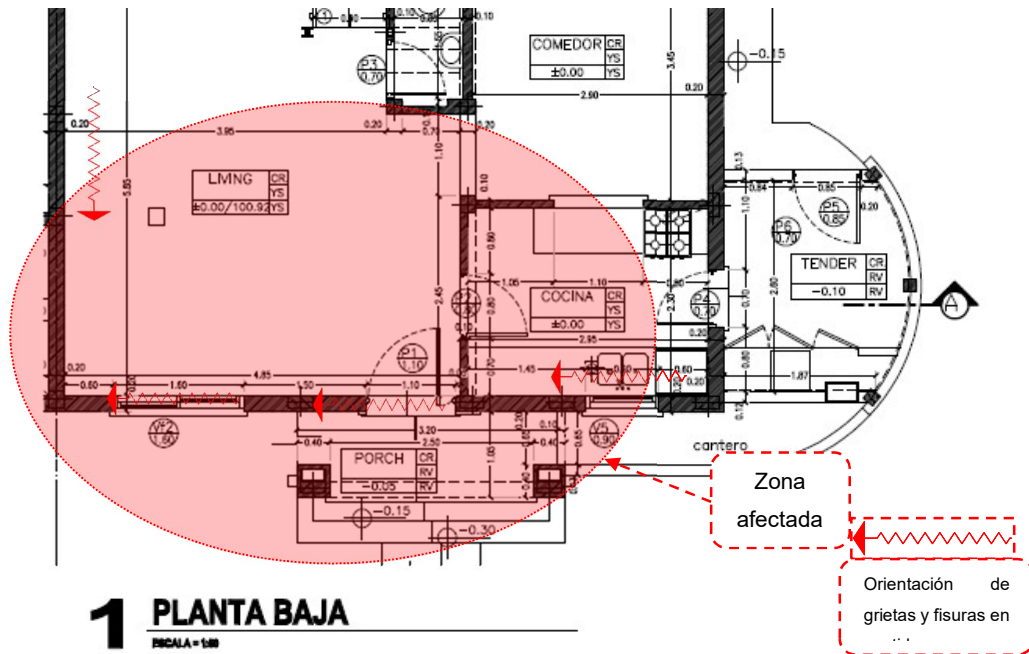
Zona de afectación - Planta Baja Casa 46
